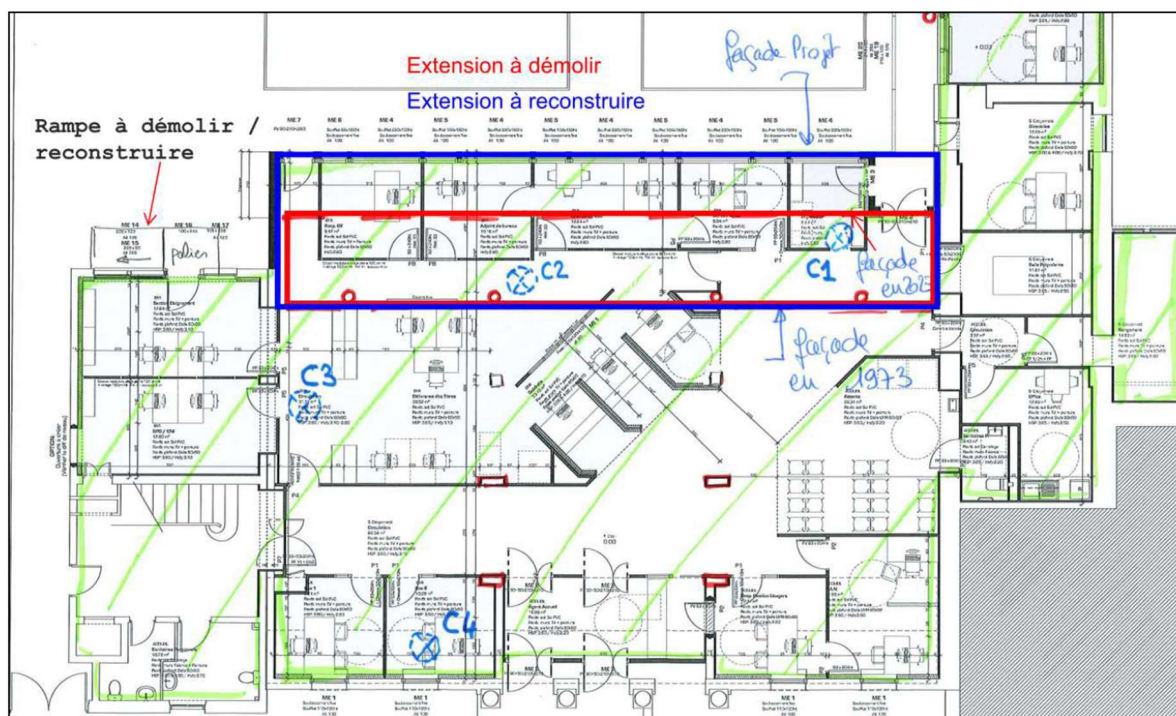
Plan masse avec projection des travaux – Echelle 1/50
